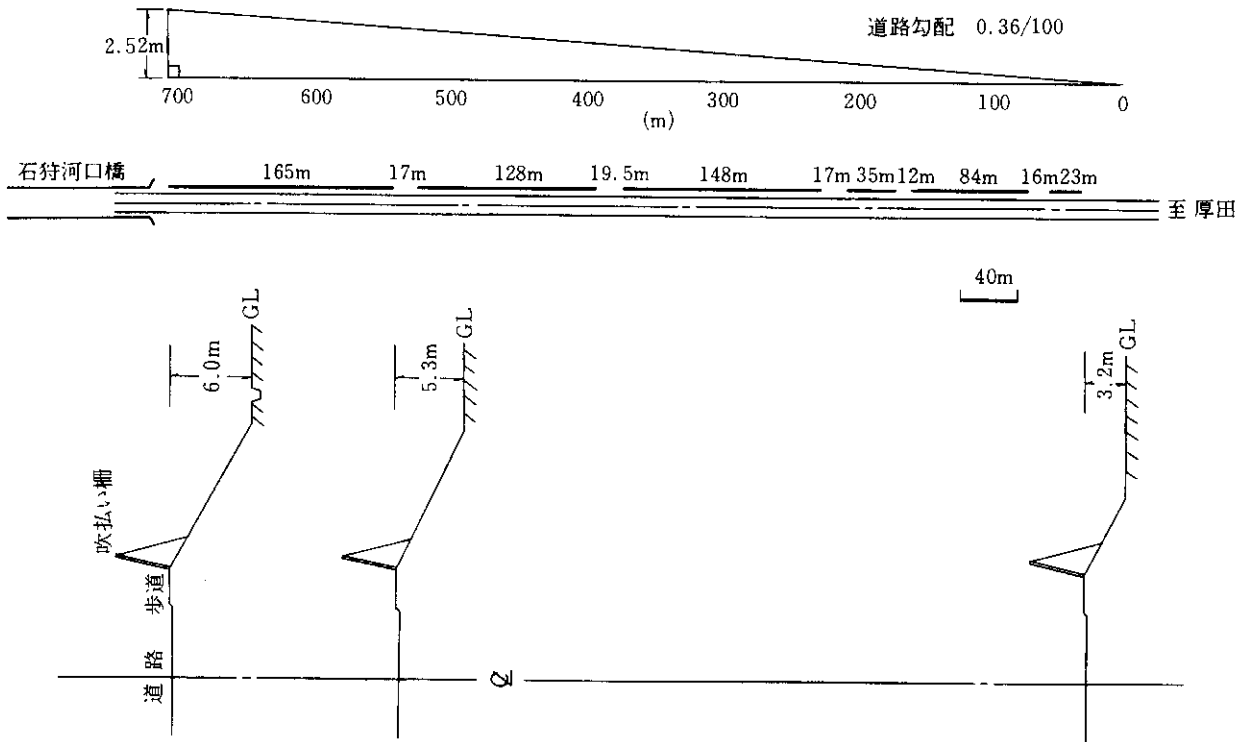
路上観測を行った吹払い柵設置区間の平面図と横断図
